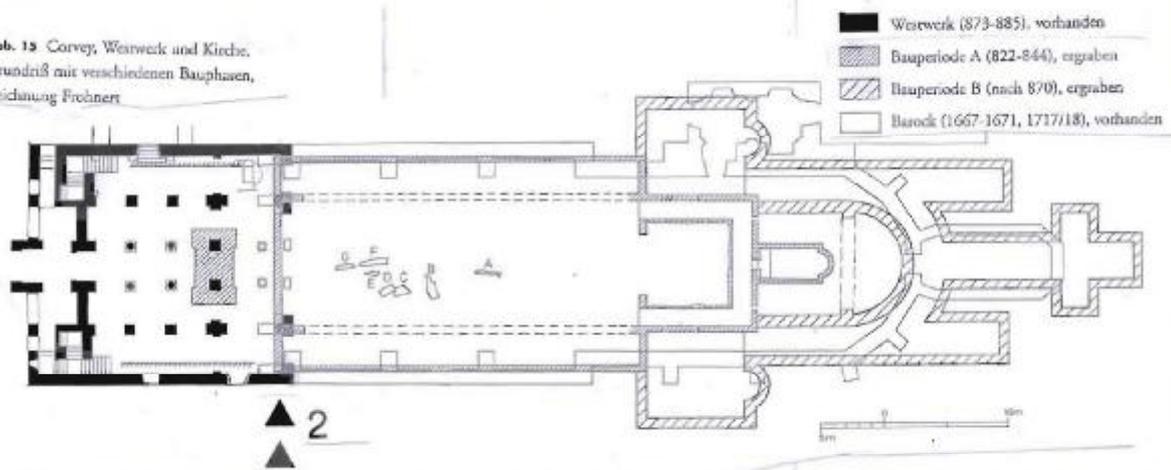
Corvey, Westwerk und Kirche, Grundriß mit verschiedenen Bauphasen, Zeichnung Frohner
